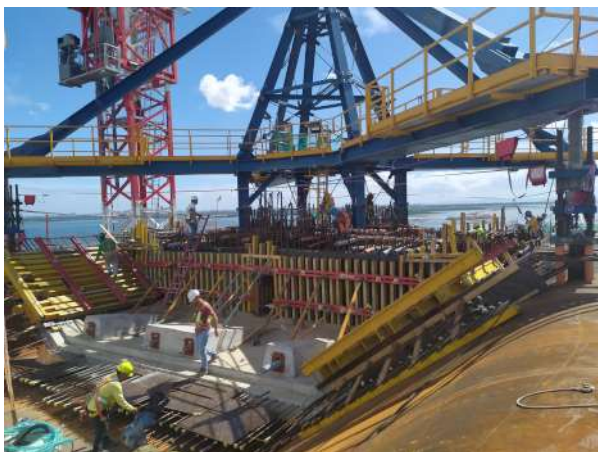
Hormigonado parcial dovelas de arranque. Estructura temporal de izado (“paraguas”)
